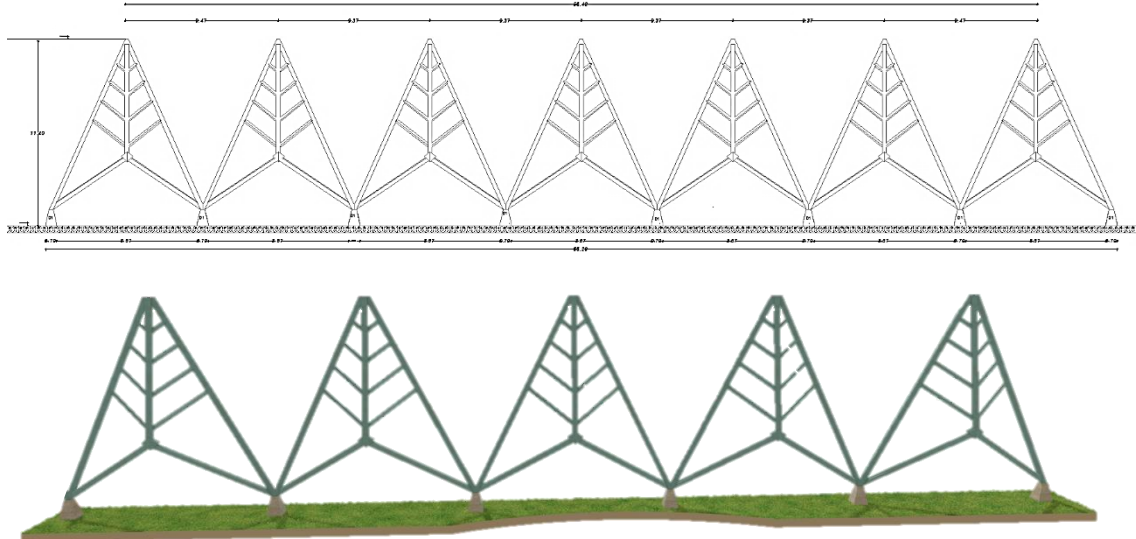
Detalle Arquitectónico Elevación Frontal – Modelado 3D.
